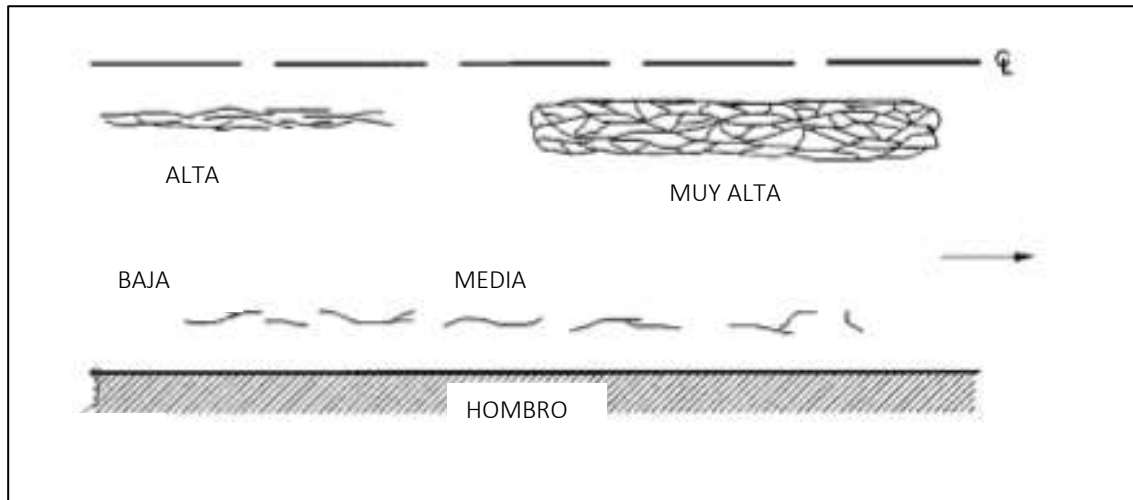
Fisuras y grietas por fatigamiento. (FHWA, 2003)
